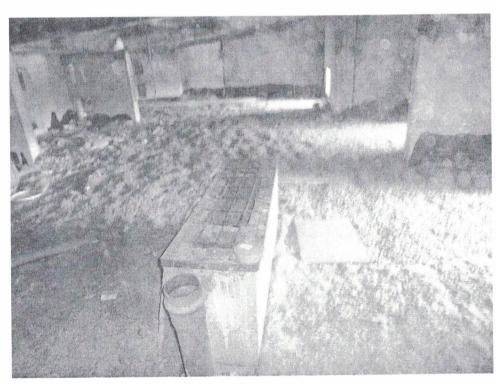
Фрагмент чердачного помещения. Вентиляционная шахта выведена только в чердачное помещение, не проходит через кровлю. Чердачное перекрытие утеплено керамзитом и минеральной ватой.
